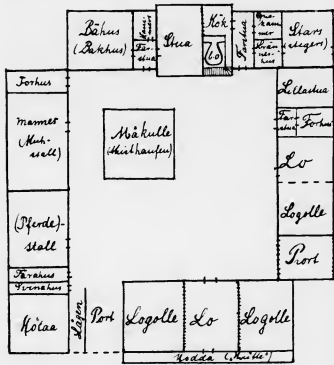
Grundriss eines dänischen Gaard
